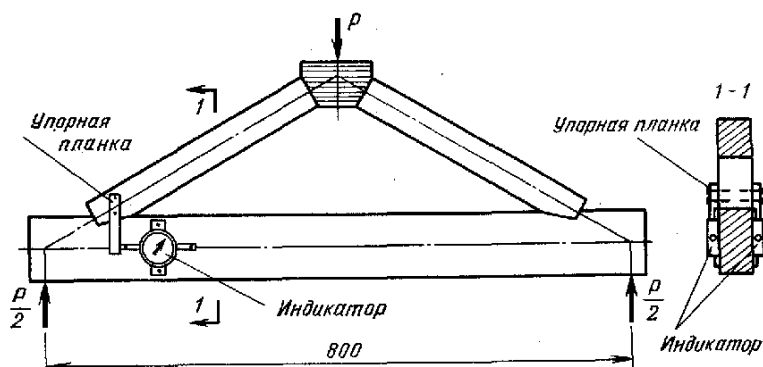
Схема испытания образца соединения на лобовой врубке и расстановка приборов
